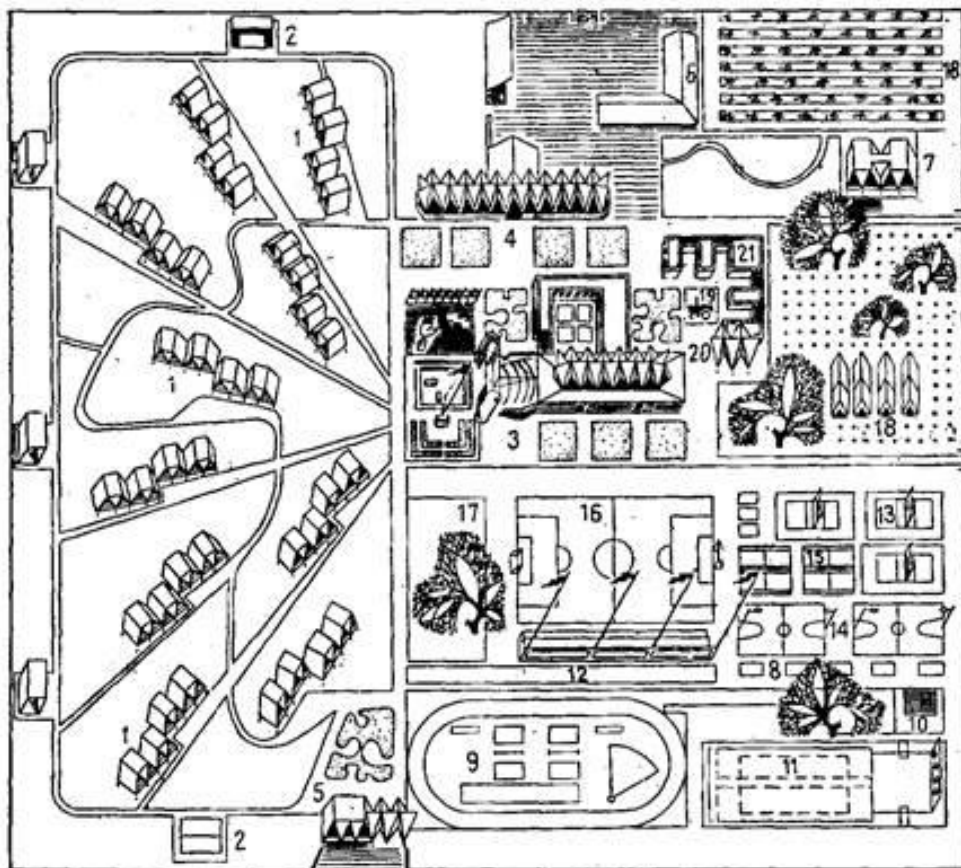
Схема генплана ОЛС на 400 жилых мест.:
